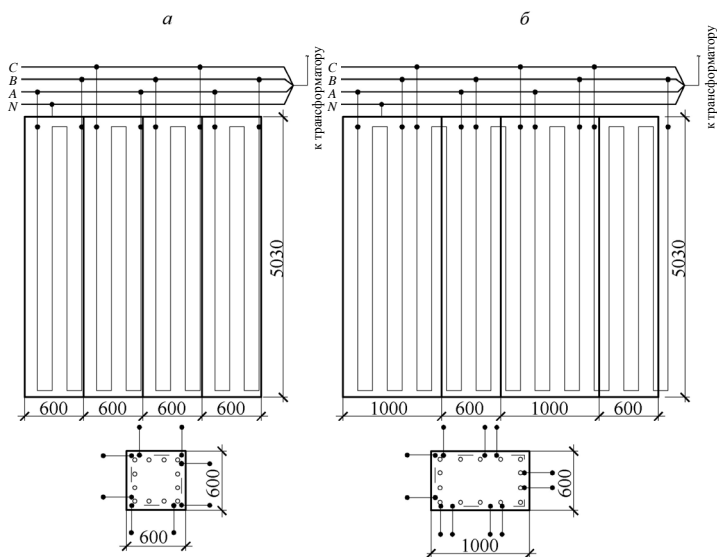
Принципиальная схема укладки греющих проводов при периферийном электропрогреве колонн:
